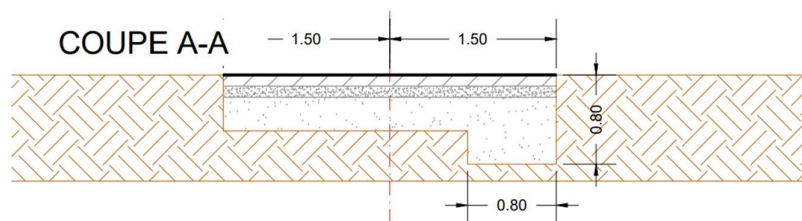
Localisation de la coupe transversale AA et la coupe à l'arrière du bâtiment 154 sur la zone 6 [R 3]
